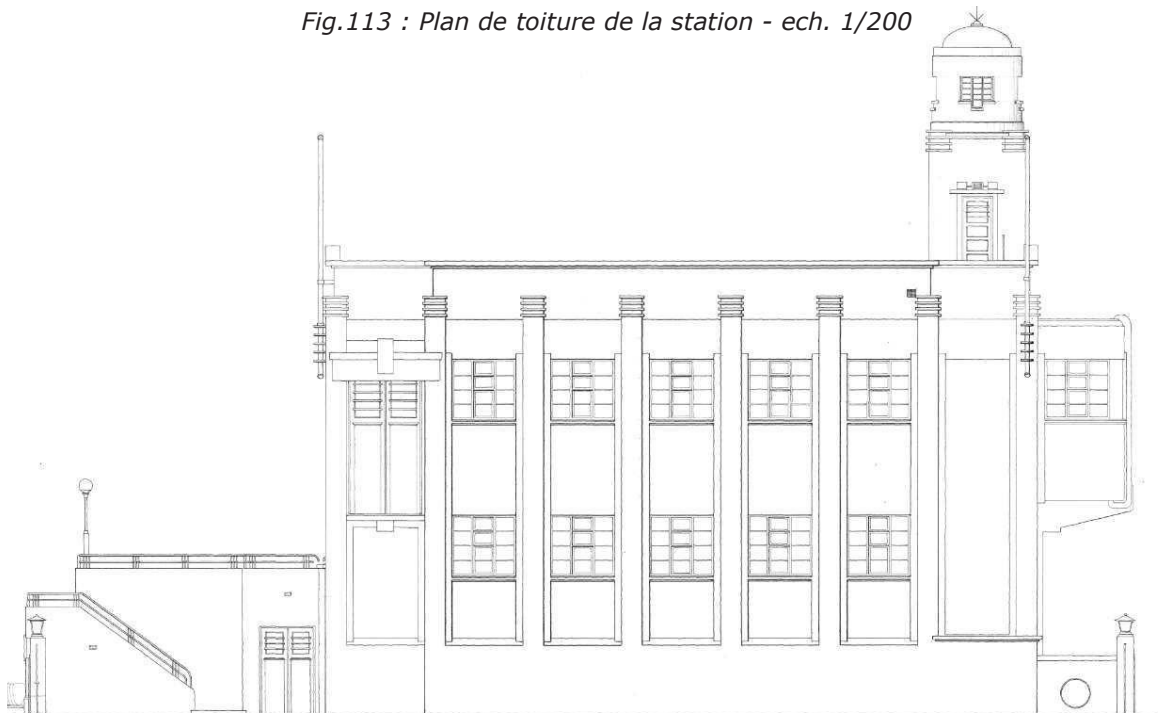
Élévation de la façade Ouest - ech. 1/200
